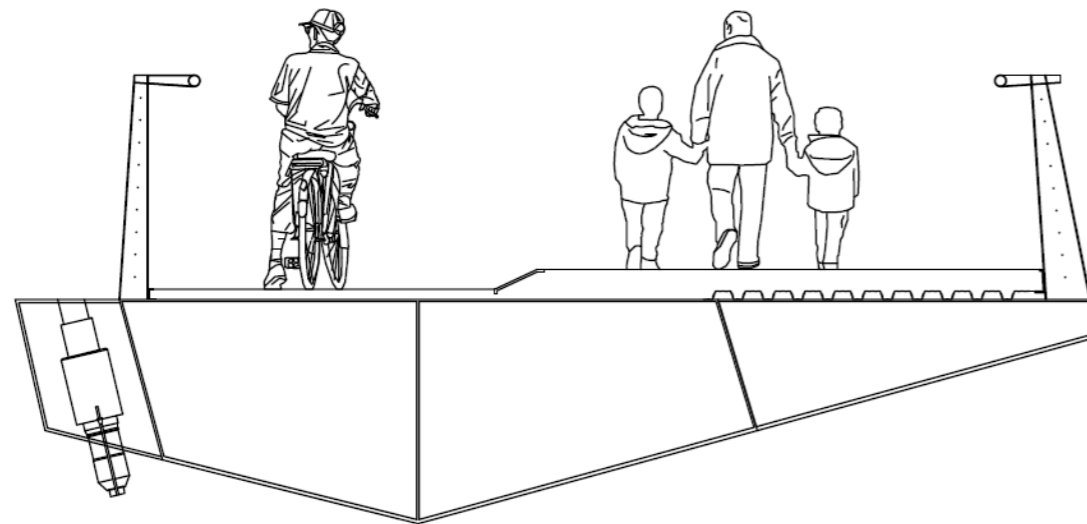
Sección del tablero adoptada para el proyecto. Fuente: Elaboración Propia (AutoCAD)
